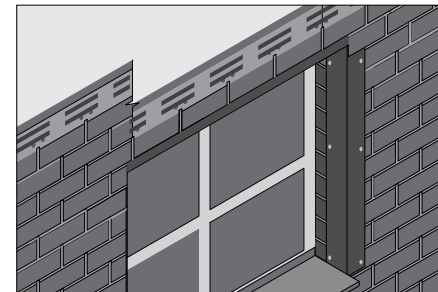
Монтаж фасадной плитки поверх оконного наличника сверху проема
